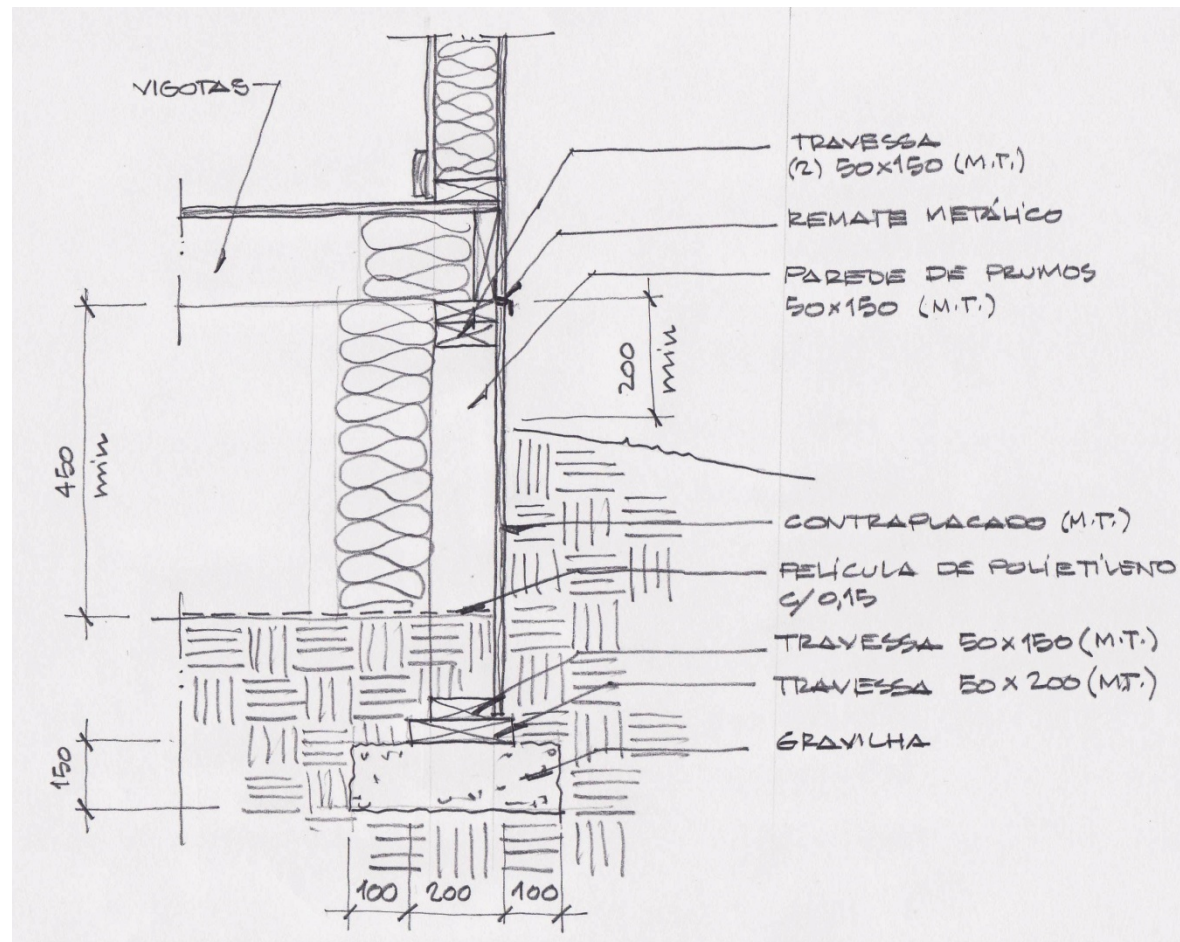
Fundações de madeira em vazio sanitário. (des. autor)
